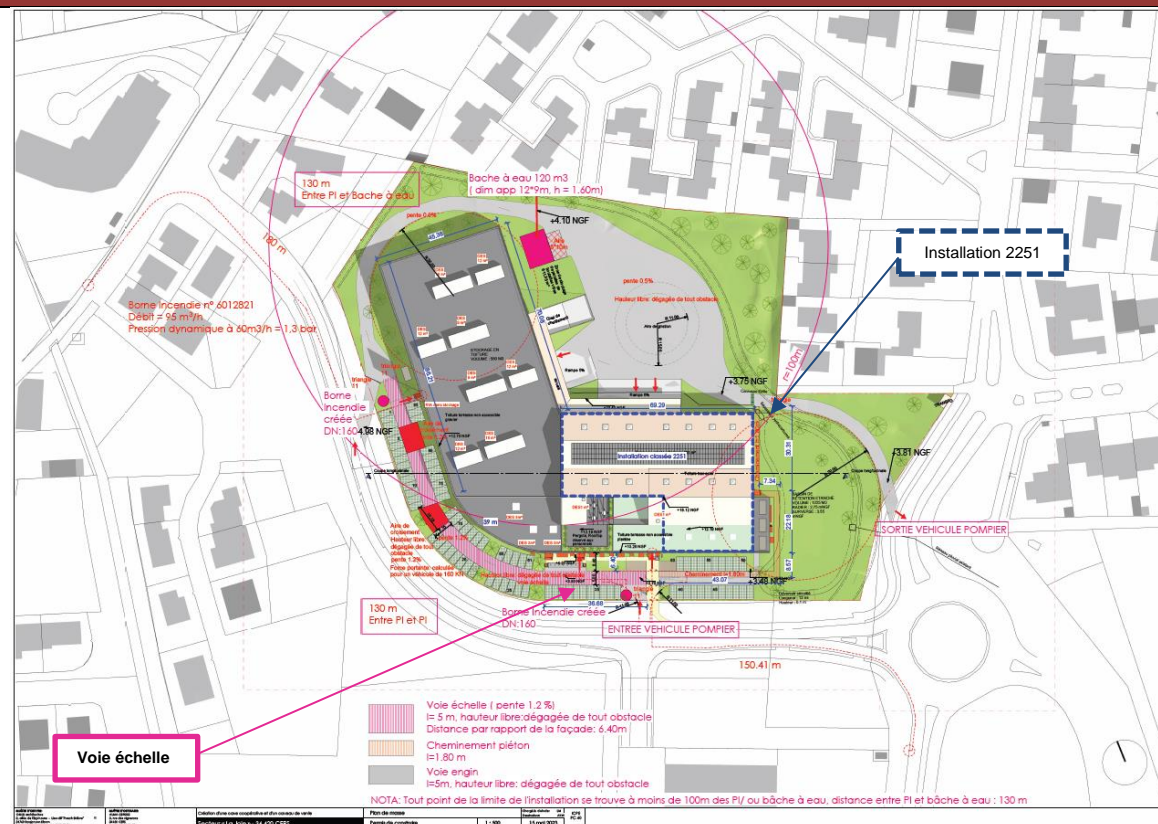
Plan de masse - Voie échelle (Source : NAOS Architecte)
